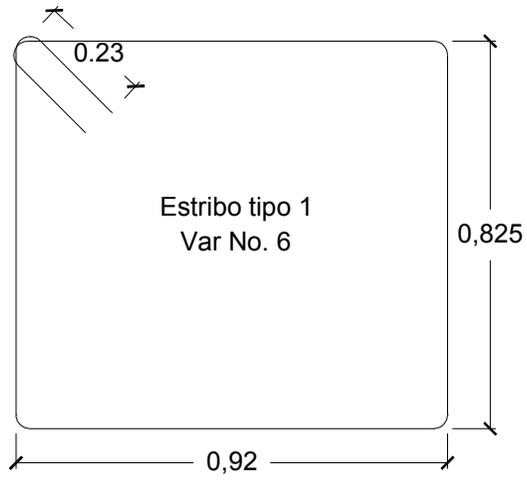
b. Estribo tipo 1, trabe de coronamiento.
